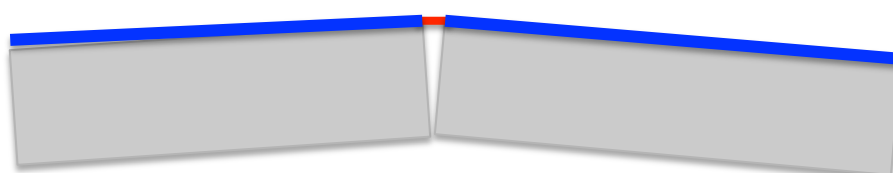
Croqui da dinâmica do ensaio de flexão dos prismas de concreto
